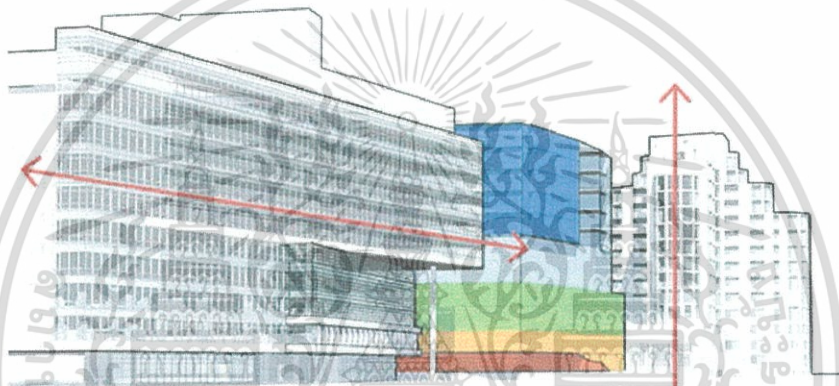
แสดงทัศนียภาพ Lunder Building, Massachusetts General Hospital
